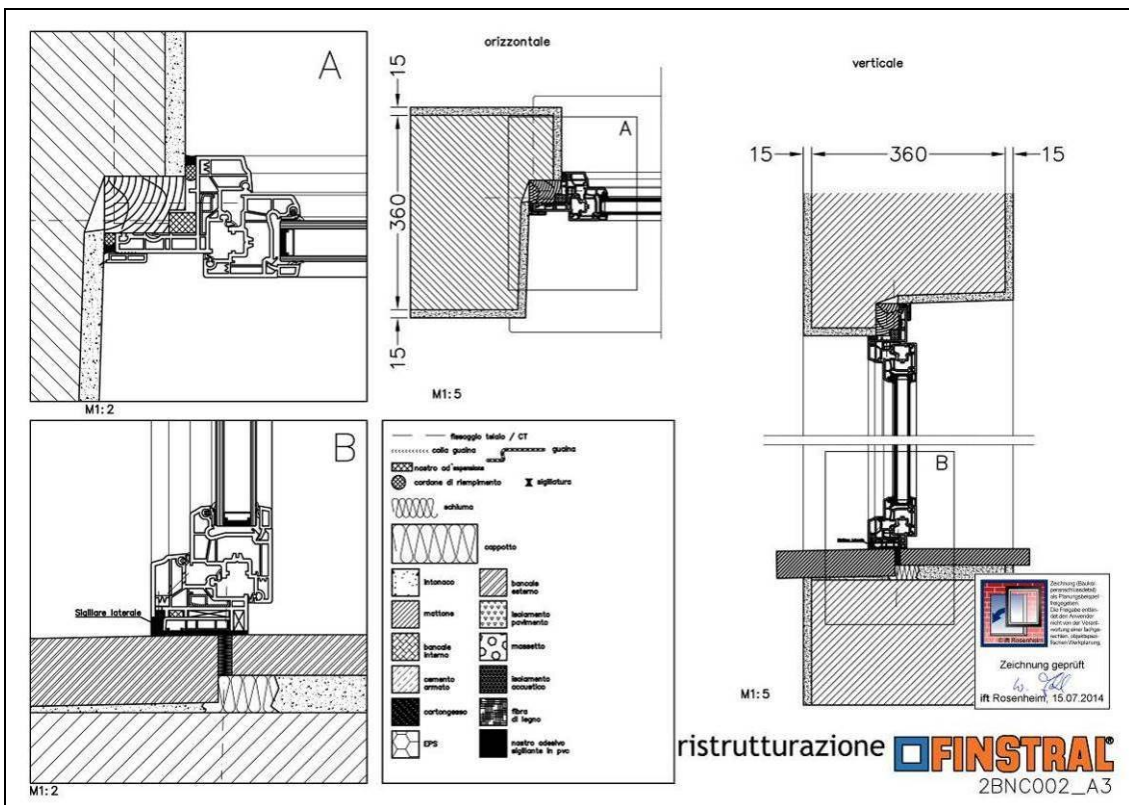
ift geprüfte Montagedetails und der Montageleitfaden sind die Grundlage einer guten Planung (Bild: Montagehinweise Fa. Finstral)
